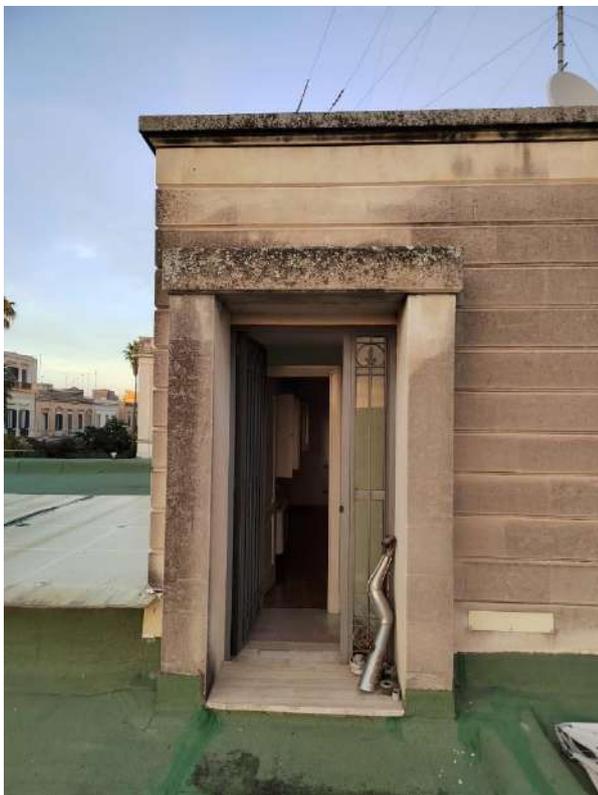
ingresso al lastrico solare	Figura 27: lastrico solare
